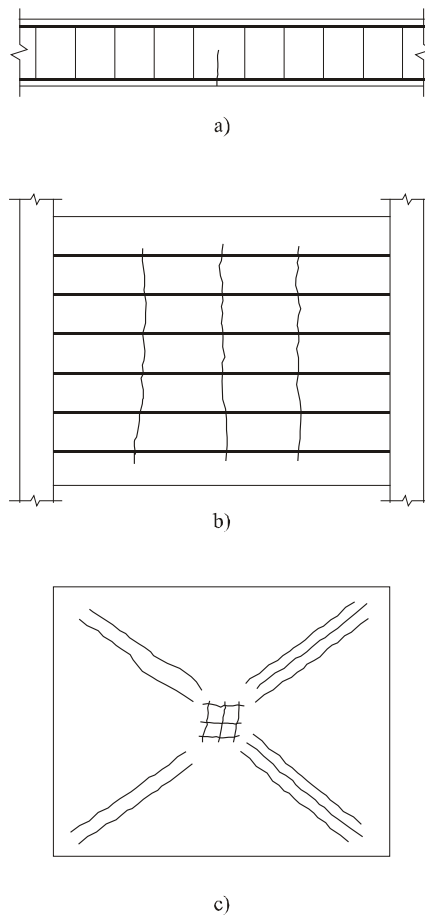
Fissuras de flexão: a) vigas; b) lajes armadas em uma direção; c) lajes armadas nas duas direções.
